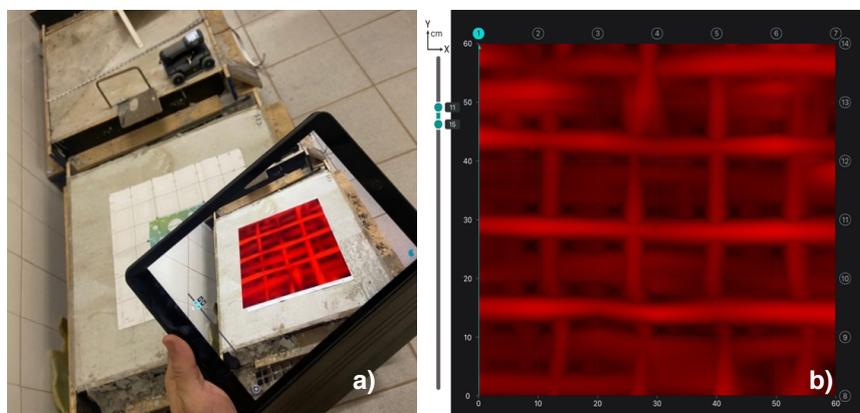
Realização do ensaio de radar GPR em laje de concreto (a) e (b) armaduras identificadas.
